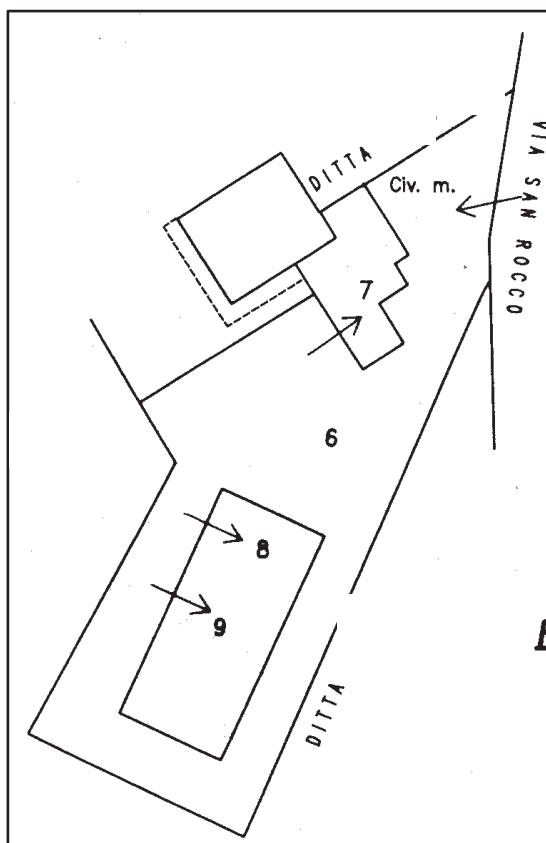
Estratto dell'elaborato planimetrico del 28.11.2001
